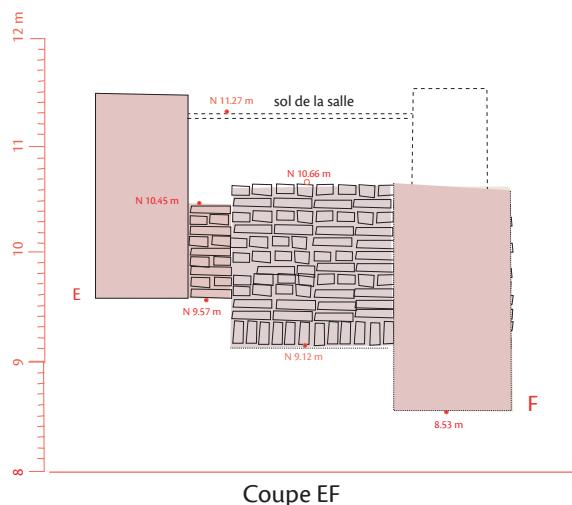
Plan et élévation du mur ouest de la chambre K.
